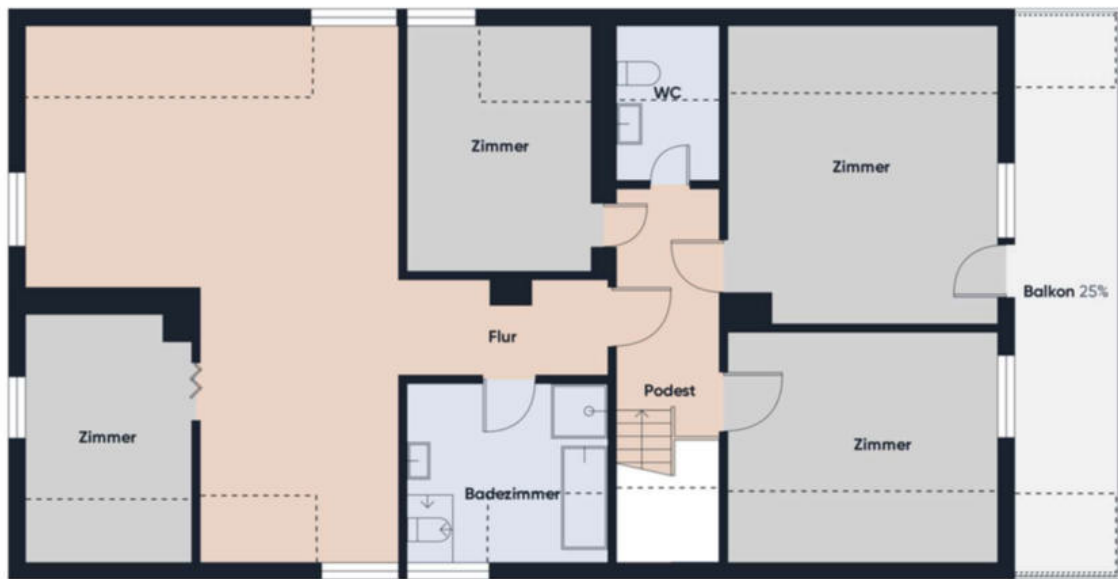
Grundriss Dachgeschoss Lidar-Messgerät zum Stichtag 2025
